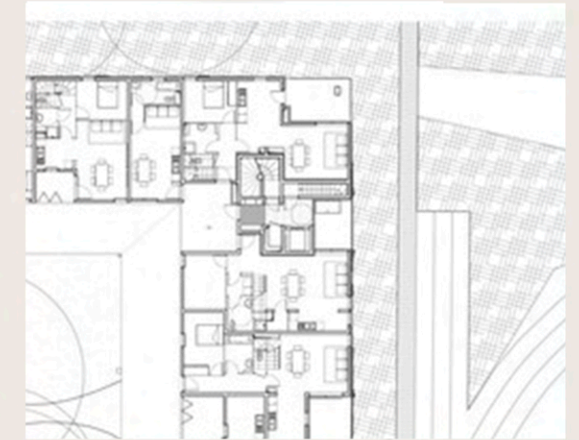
| Tipo dúplex. Fuente: ArchDaily
